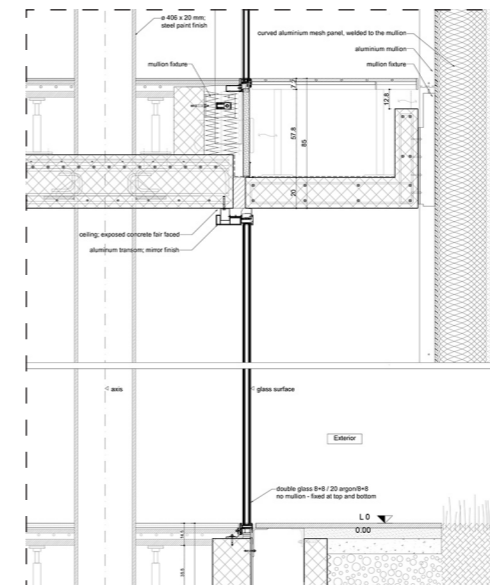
Detalle constructivo Campus Bocconi. SANAA.
